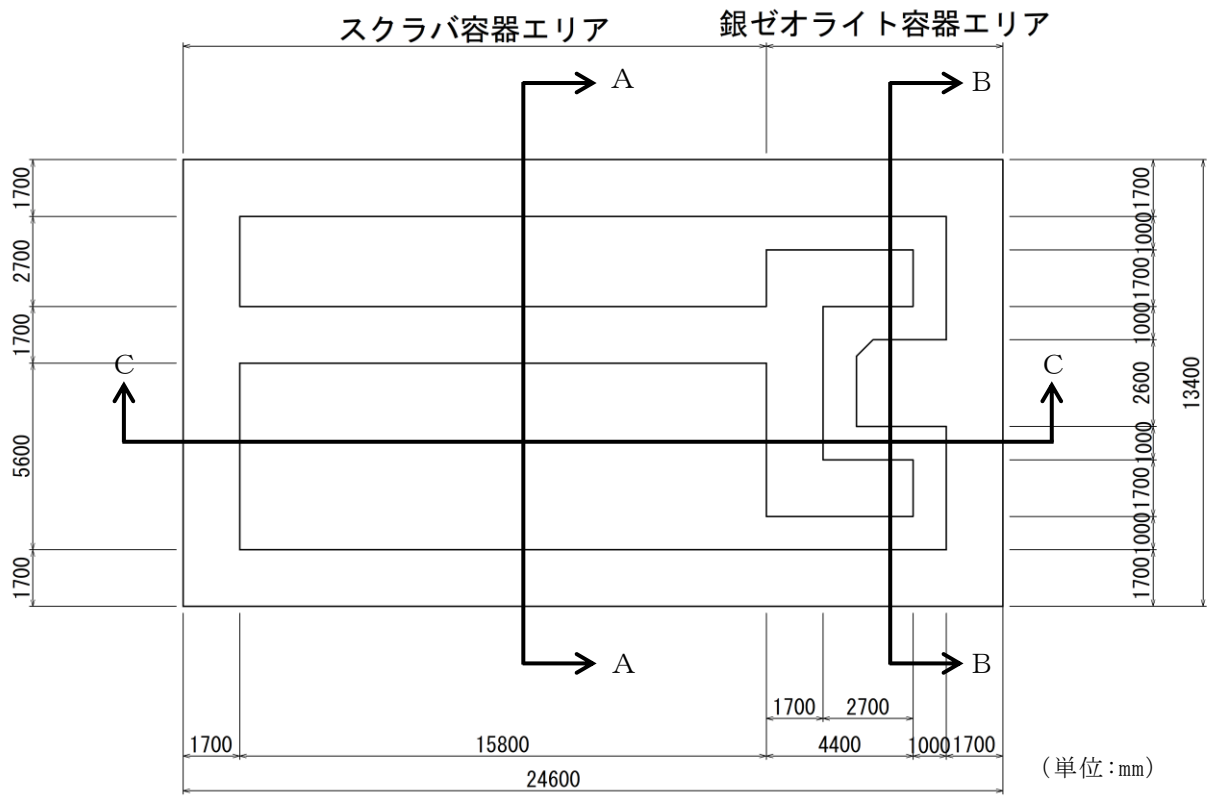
第 1 ベントフィルタ格納槽 平面図
